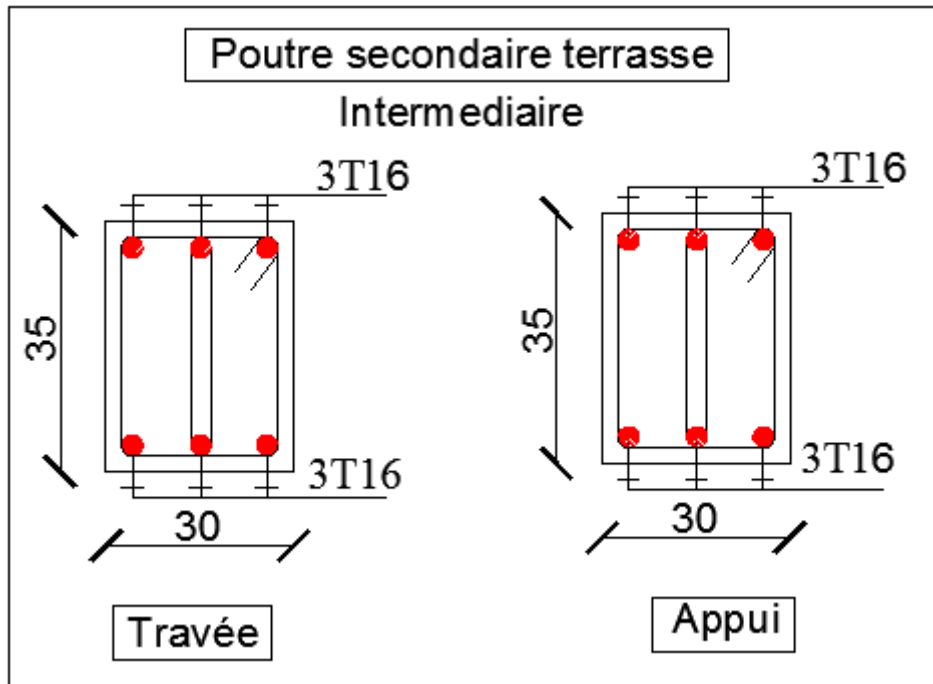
Ferrailage des poutres secondaires intermédiaires du niveau terrasse.
